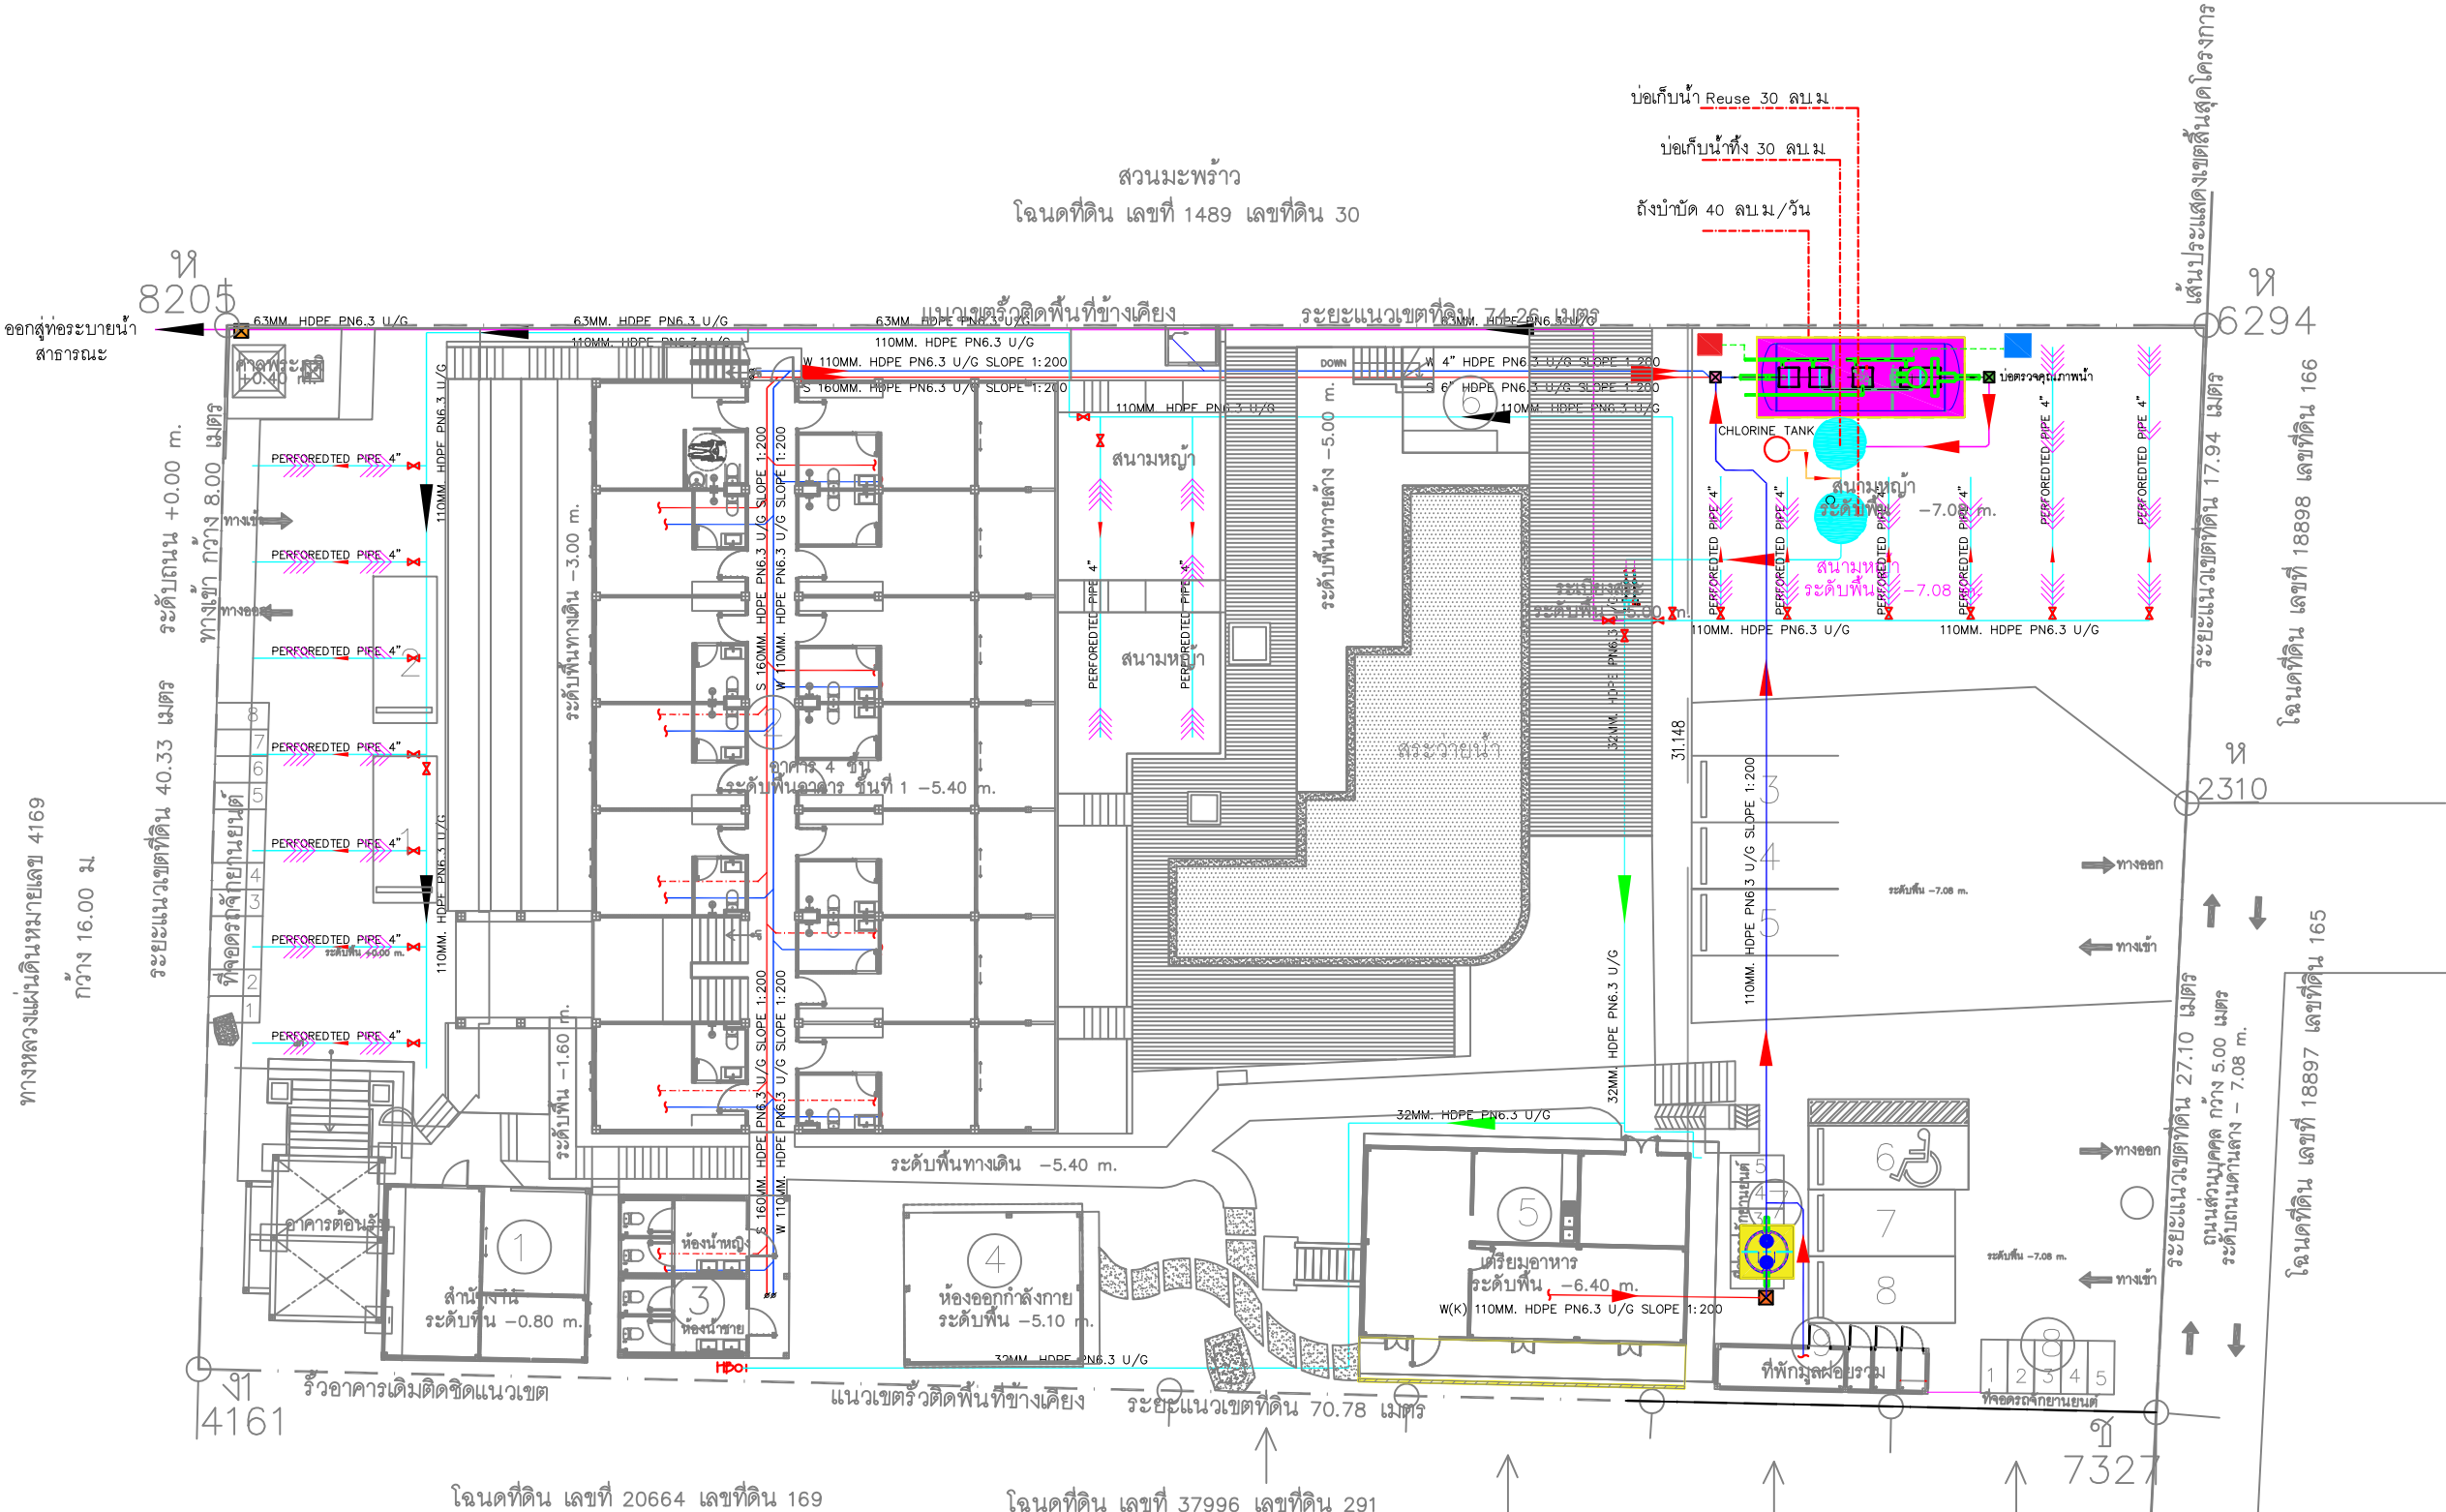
ผังระบบน้ำเสียของโครงการ
